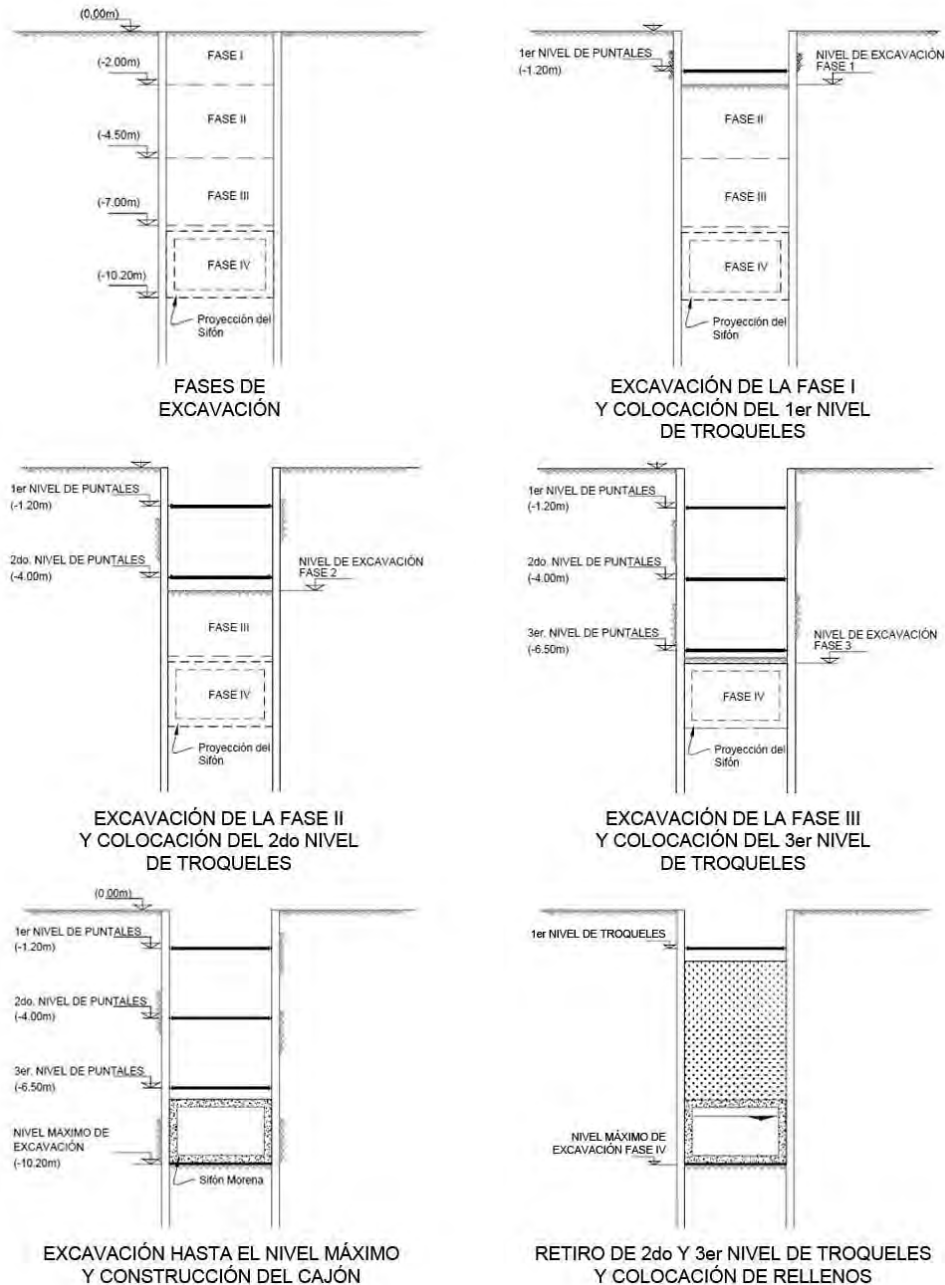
Proceso constructivo del Sifón Morena.
